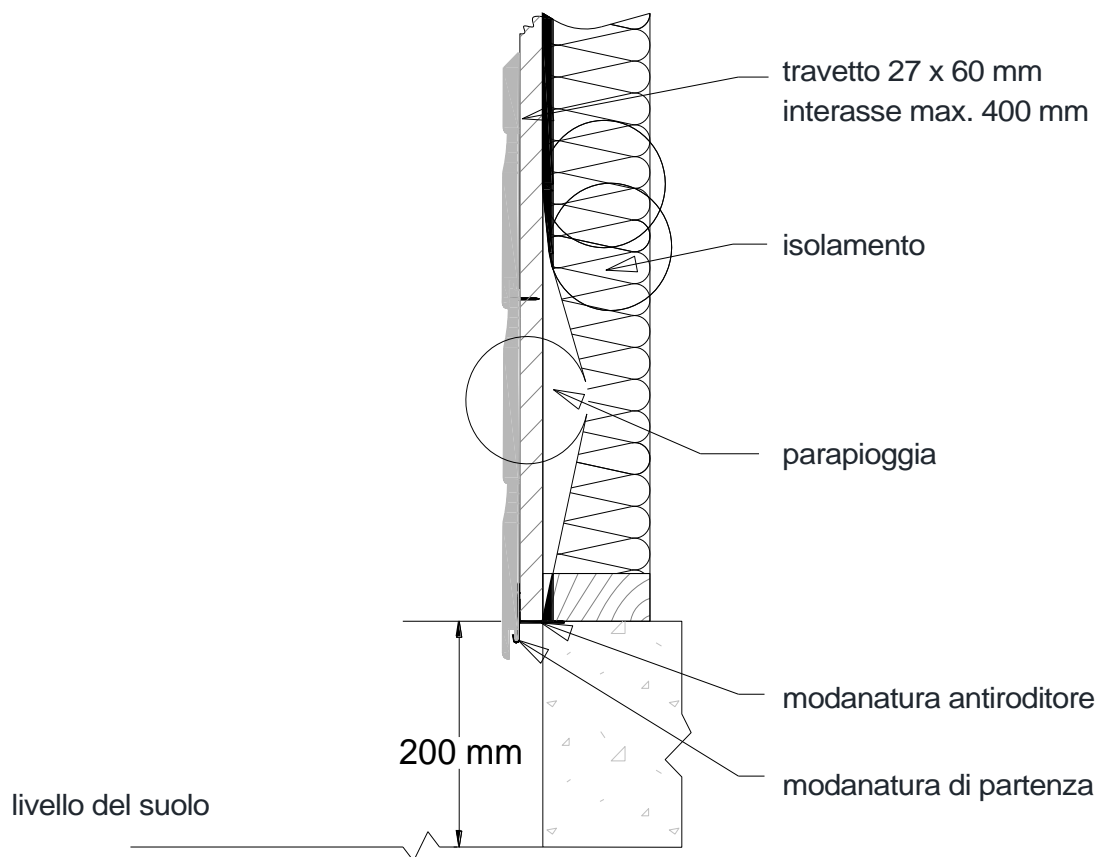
Sezione verticale su costruzione con struttura in legno – Posa orizzontale
